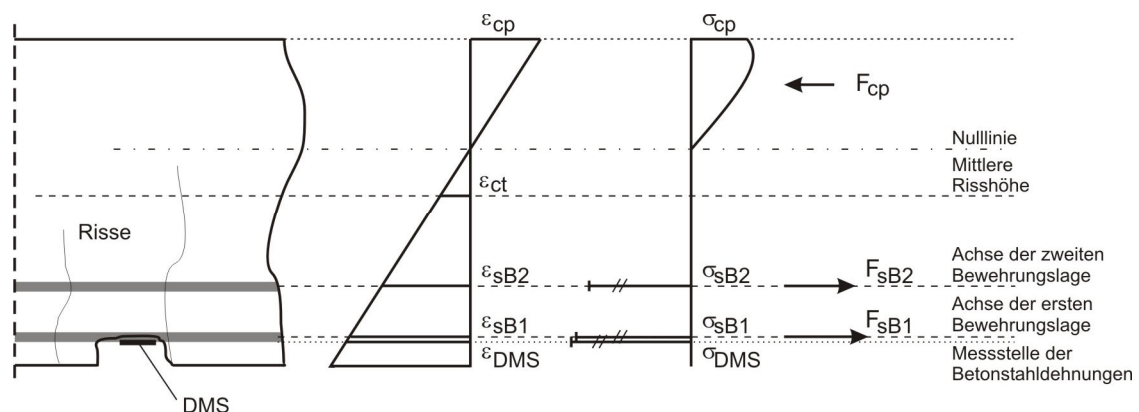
Berechnungsmodell zur Ermittlung der Betonstahldehnungen
